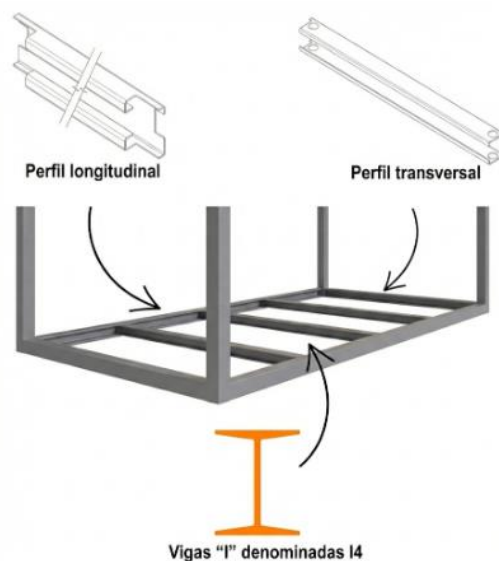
Identificação dos elementos estruturais do módulo: a) estrutura externa do módulo; (b) subestruturas do módulo
